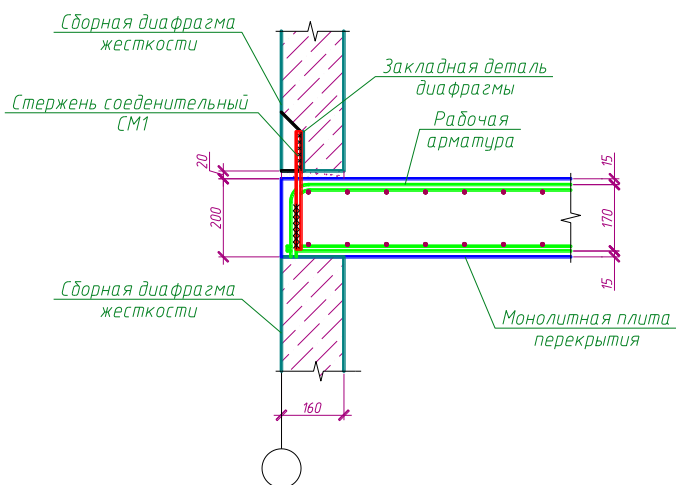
Крепление низа внутренней стеновой панели при монтаже к монолитному перекрытию
